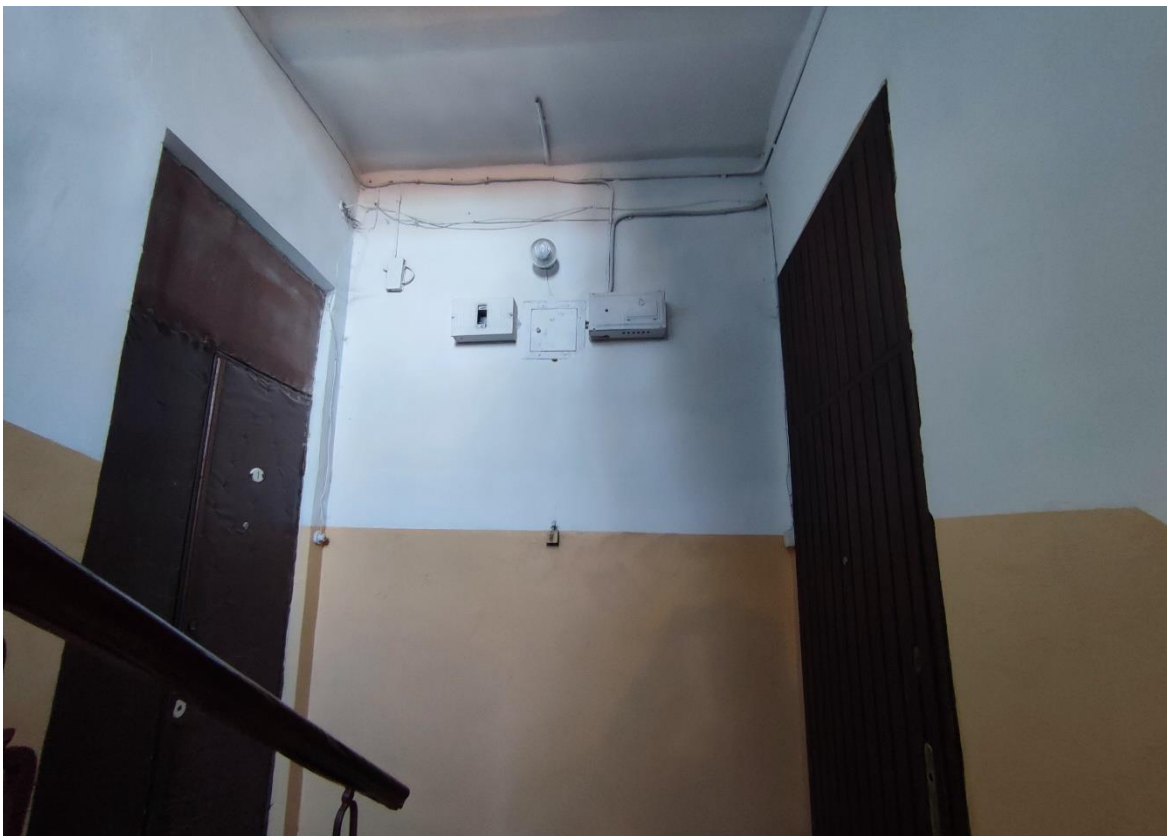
1-ый этаж лестничной клетки ЛК-1. Расположение электропроводки по стенам с нарушением способа прокладки.
